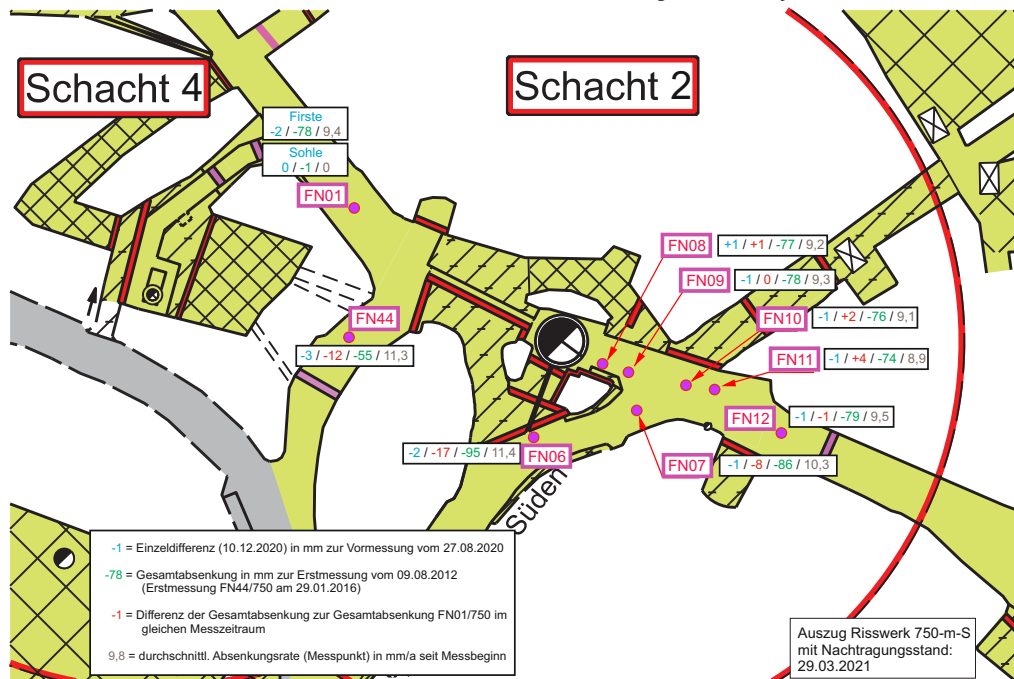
Grundrissausschnitt 750-m-S mit Lage / Senkungsdifferenzen der Firstnivellelementpunkte (Messpunkte abgekürzt ohne Angabe der Sohle (/750) dargestellt)
